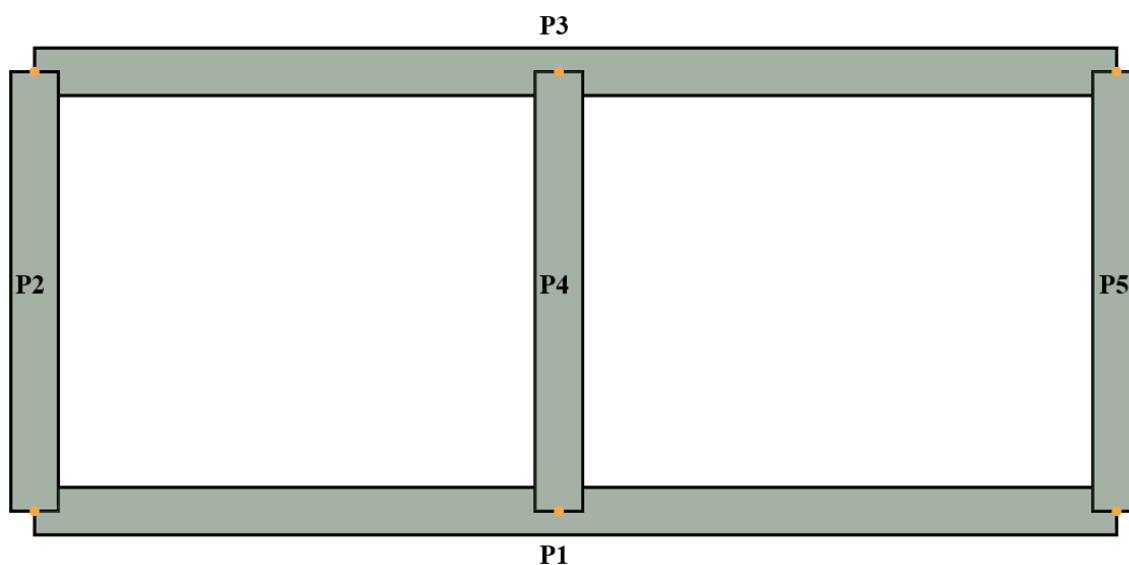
Pianta con indicazione delle pareti - Modello Collegato
